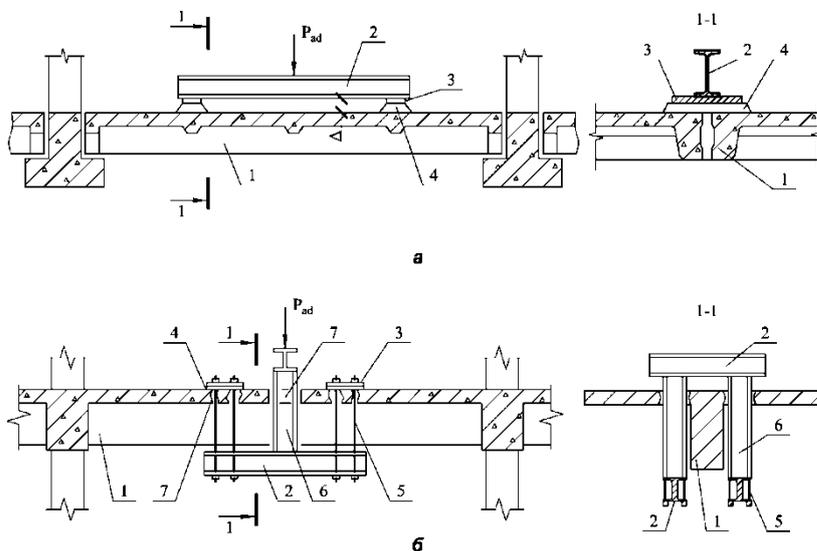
Усиление конструкций изменением места передачи нагрузки: а – при расположении распределительных устройств сверху конструкции; б – то же, снизу конструкции; 1 – усиливаемая конструкция; 2 – распределительная балка; 3 – опорная пластина; 4 – цементно-песочный раствор; 5 – тяжи; 6 – стойка; 7 – отверстия в перекрытии
